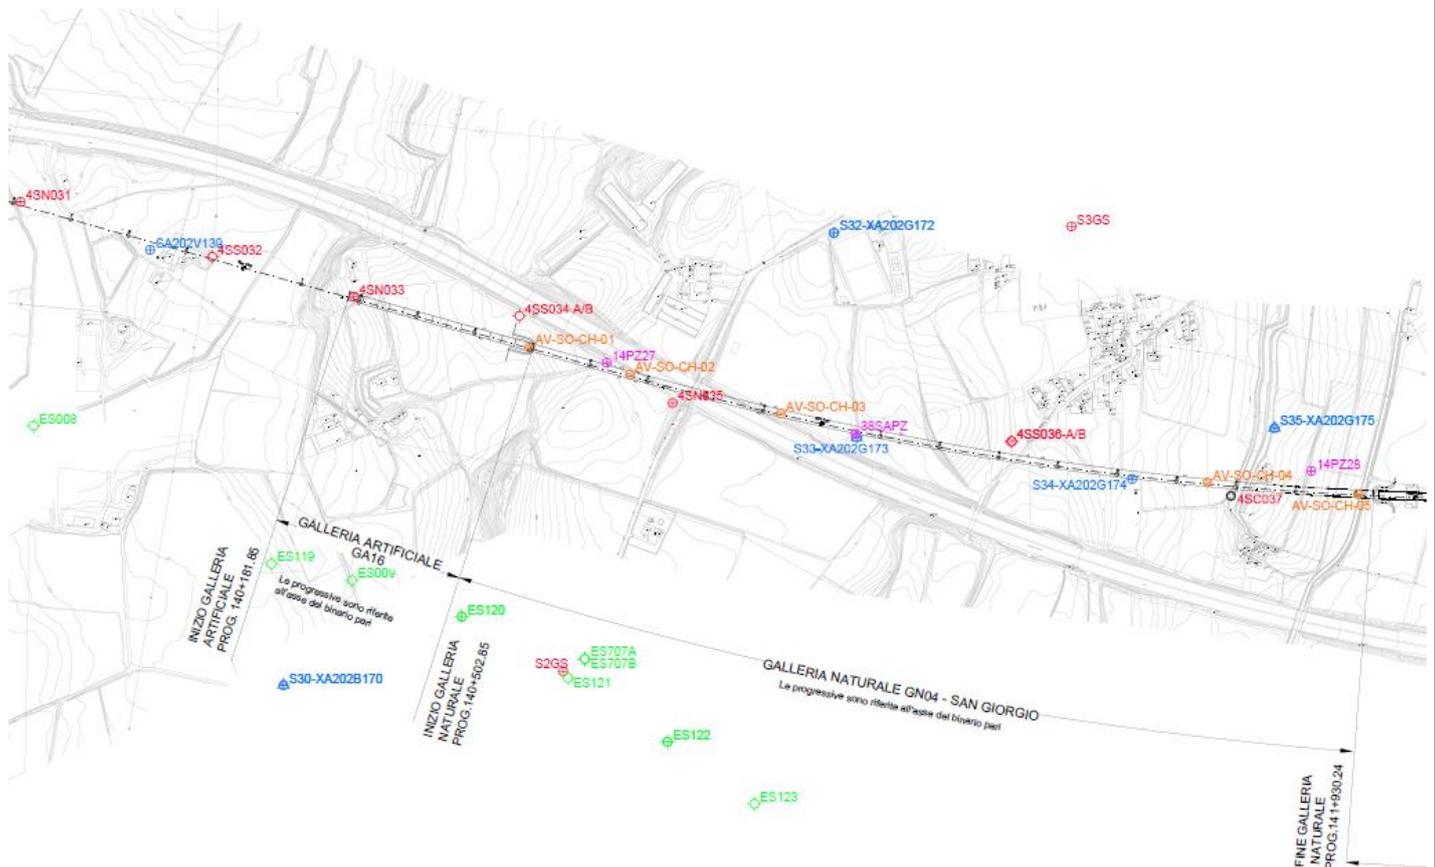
Galleria S.Giorgio in Salici, planimetria di progetto della galleria naturale con l'ubicazione delle indagini geotecniche.
